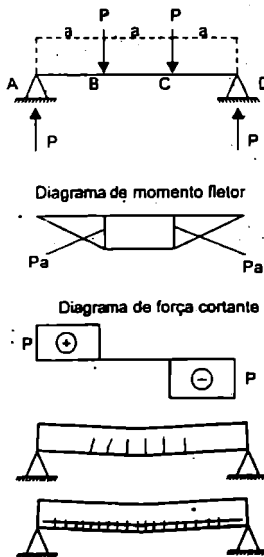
Comportamento de uma viga de concreto simplesmente apoiada.
